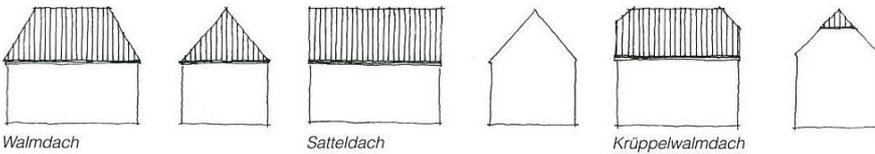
Bevorzugte Dachform ist das Satteldach mit steiler Dachneigung
